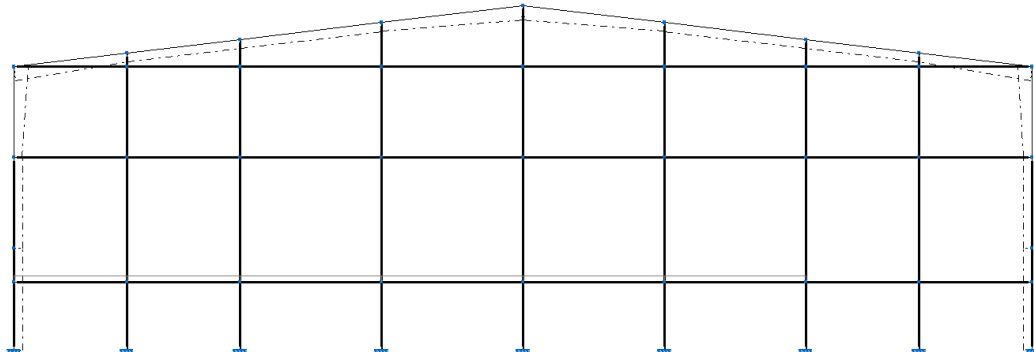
Carga entrepiso gimnasio sobre pórtico posterior (h=3m)
